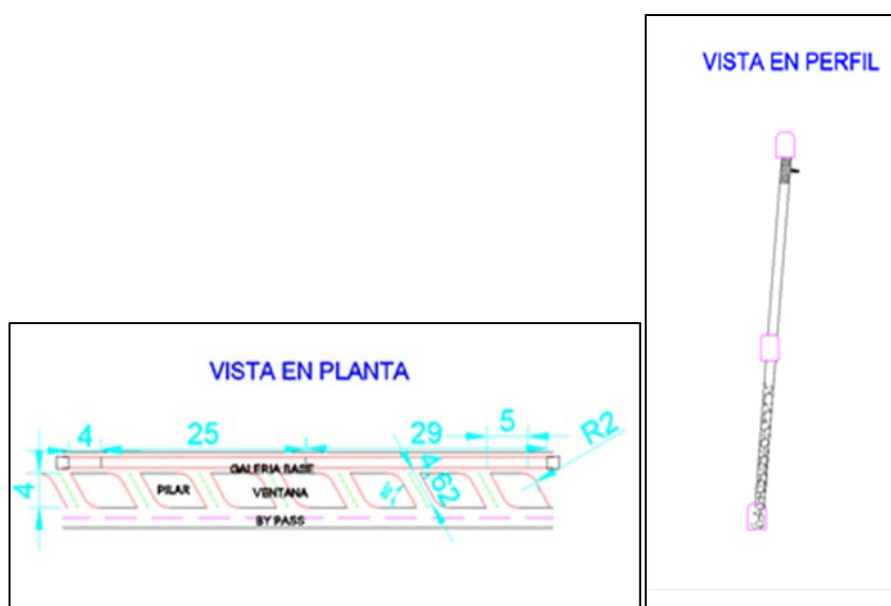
Vista en planta de la zona inferior y vista en perfil.
